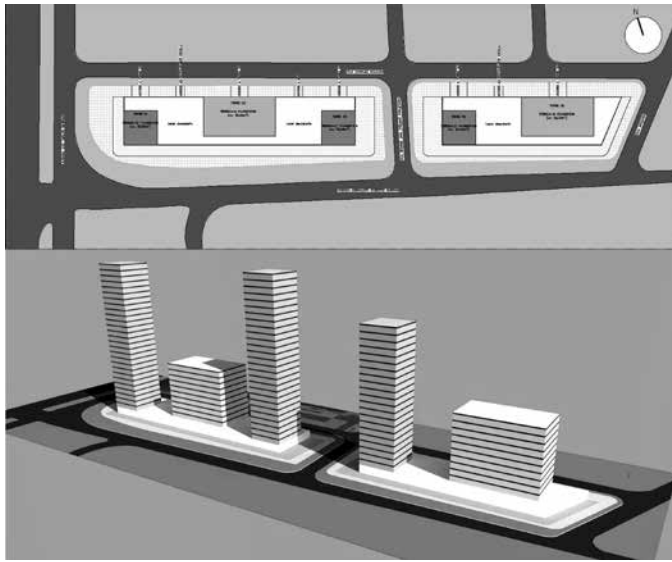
Retrata a variante da implantação e da nova volumetria.
